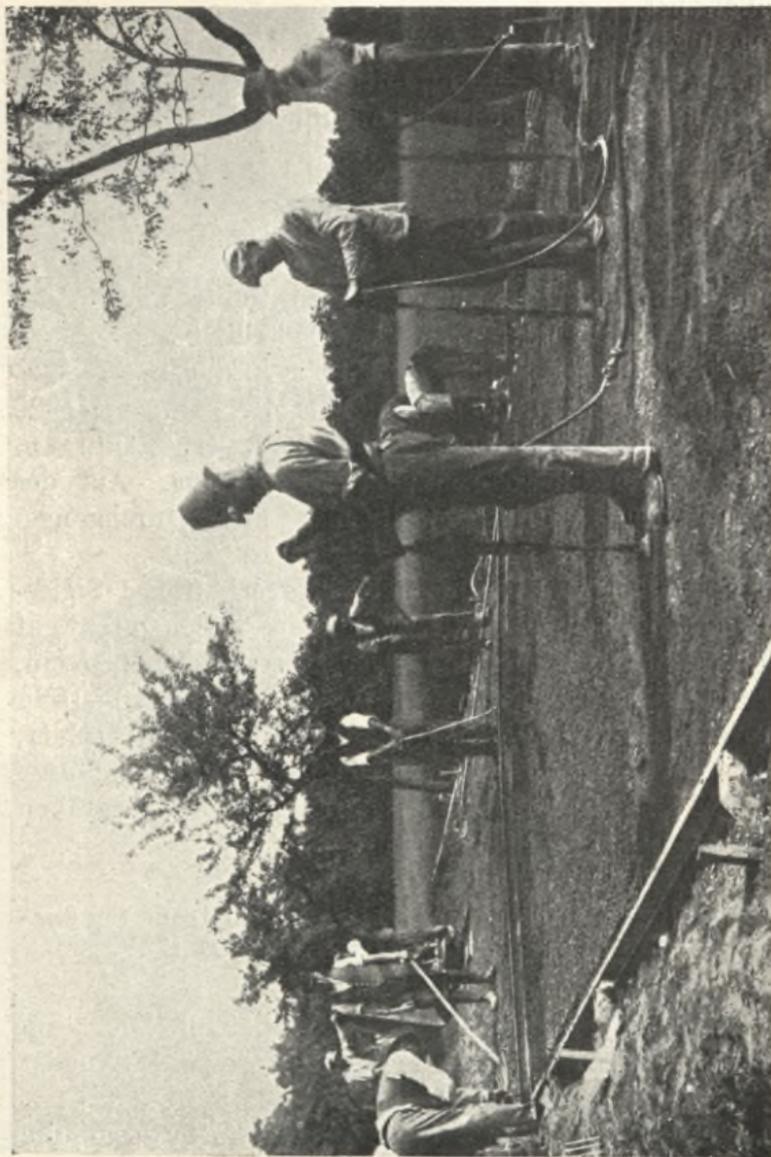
Soliditit-Betonstraße bei Drensteinfurt. Preßluftstempfung.
